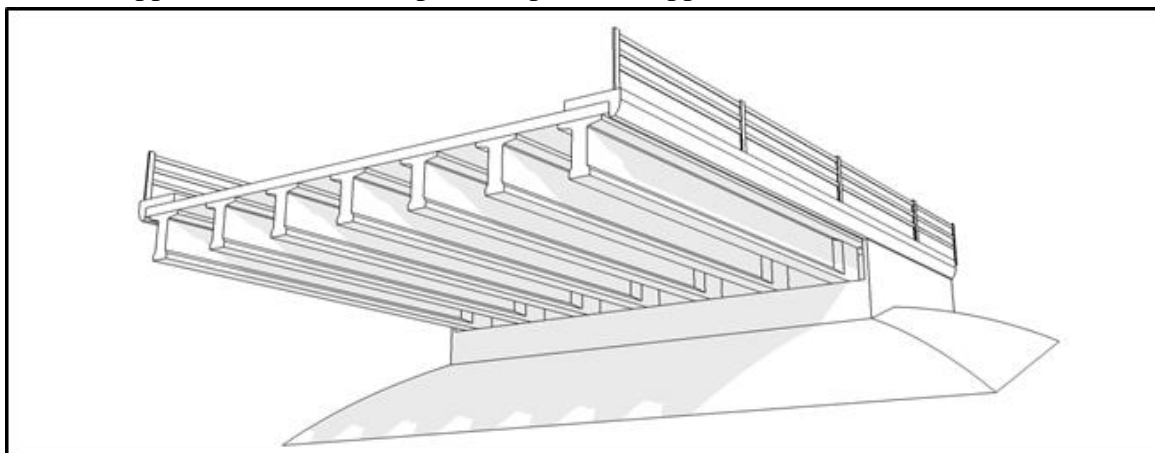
Morphologie générale d'un pont à poutres en béton précontraint.
